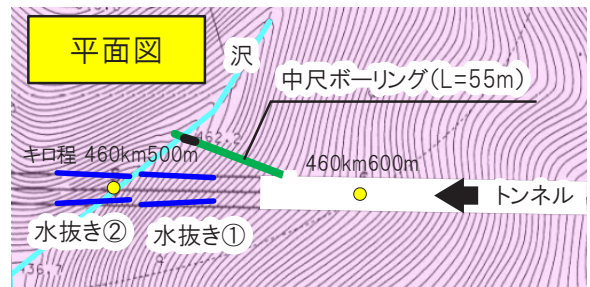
試験位置平面図 (新北陸トンネル) (Geological Plan View at Shin-Hokuriku Tunnel)
